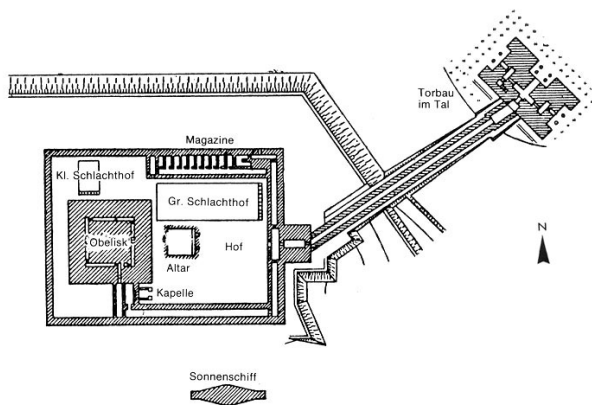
Grundriss Sonnenheiligtum Niuserre
